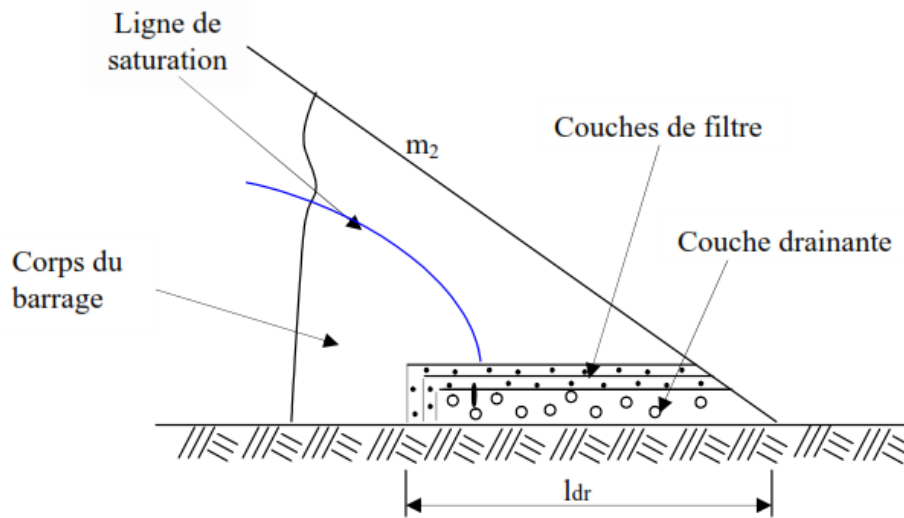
Prisme de drainage avec drainage de surface [Messaid 2009].
